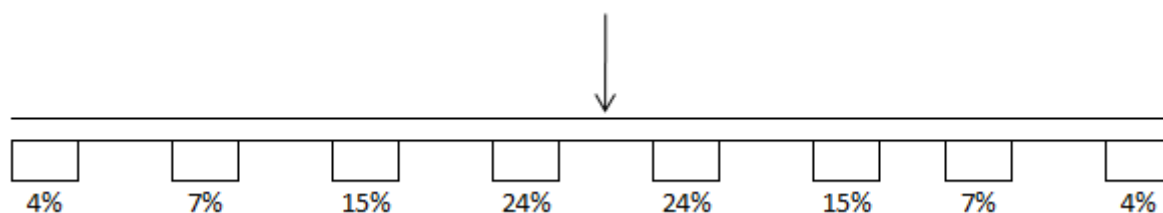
Distribuição da carga pelas travessas adjacentes ao ponto de aplicação. Carga entre travessas
